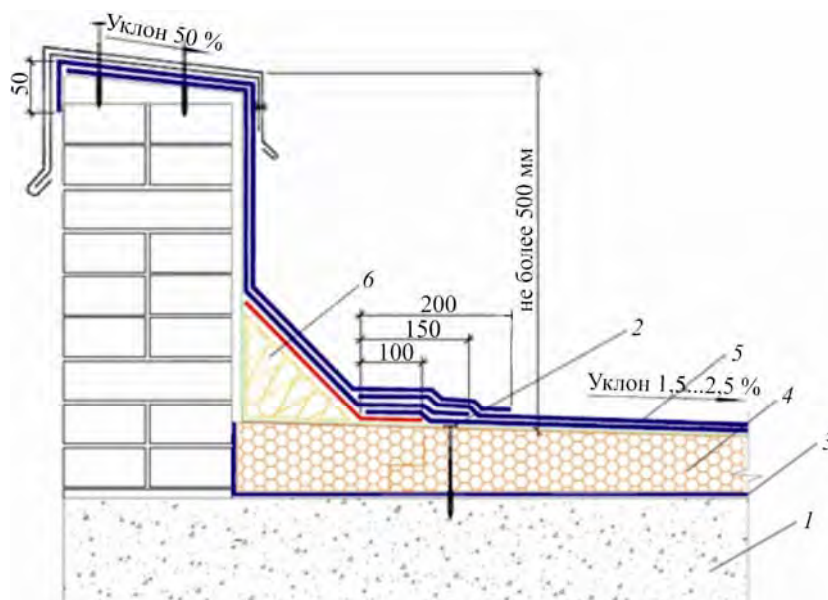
Плоская крыша: 1 — плита перекрытия; 2 — крепление утеплителя; 3 — пароизоляция; 4 — утеплитель; 5 — гидроизоляционный ковер; 6 — дополнительное утепление
